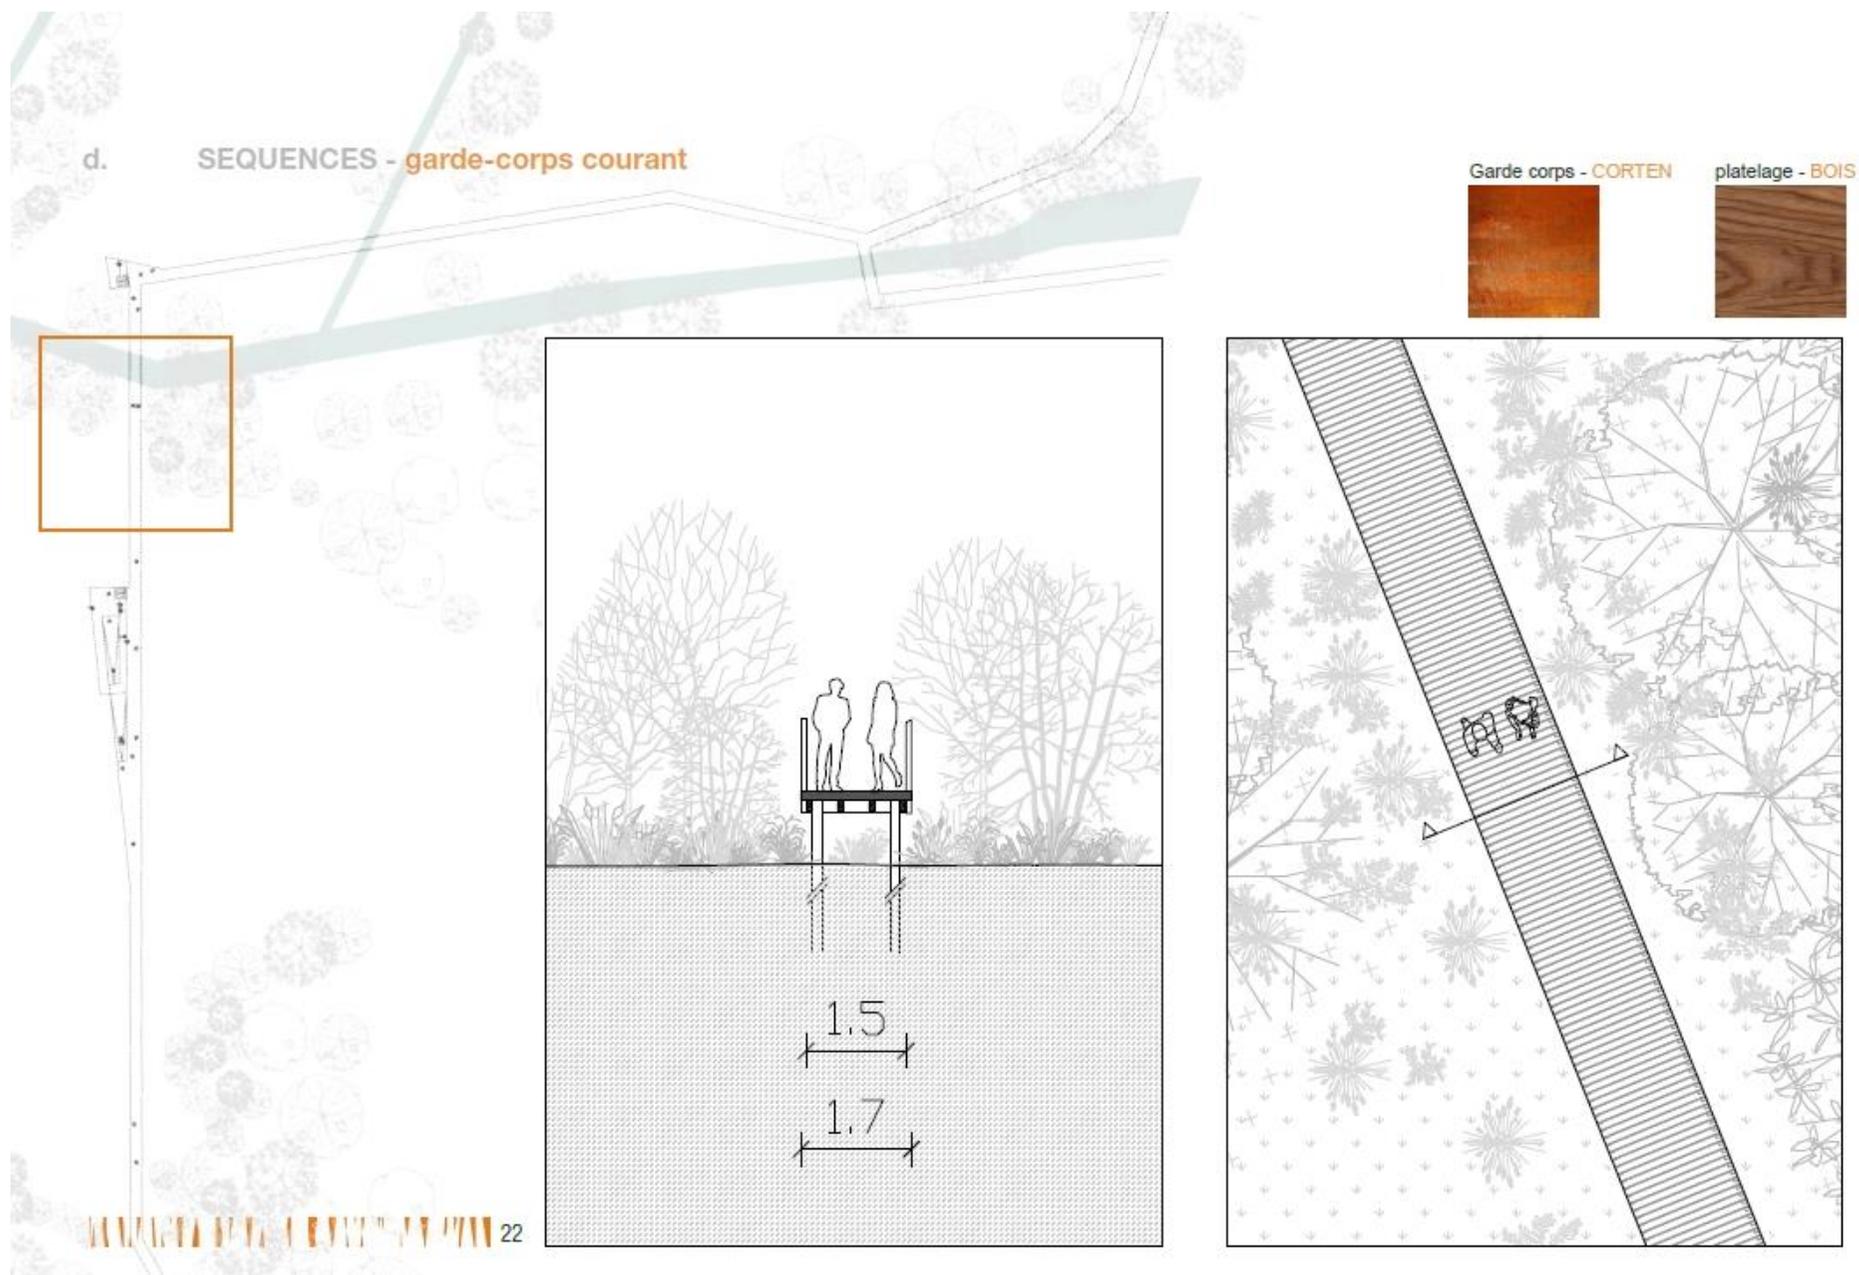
Schéma constructif type du projet de passerelle sur pilotis (Source : Atelier Arcau)
